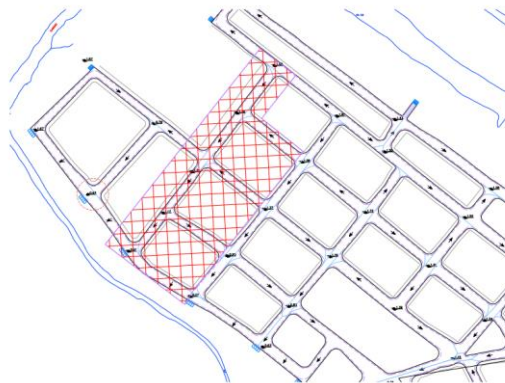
Sub-Bacia 01, trecho mais solicitado Fonte: Planta autoral Autocad.
